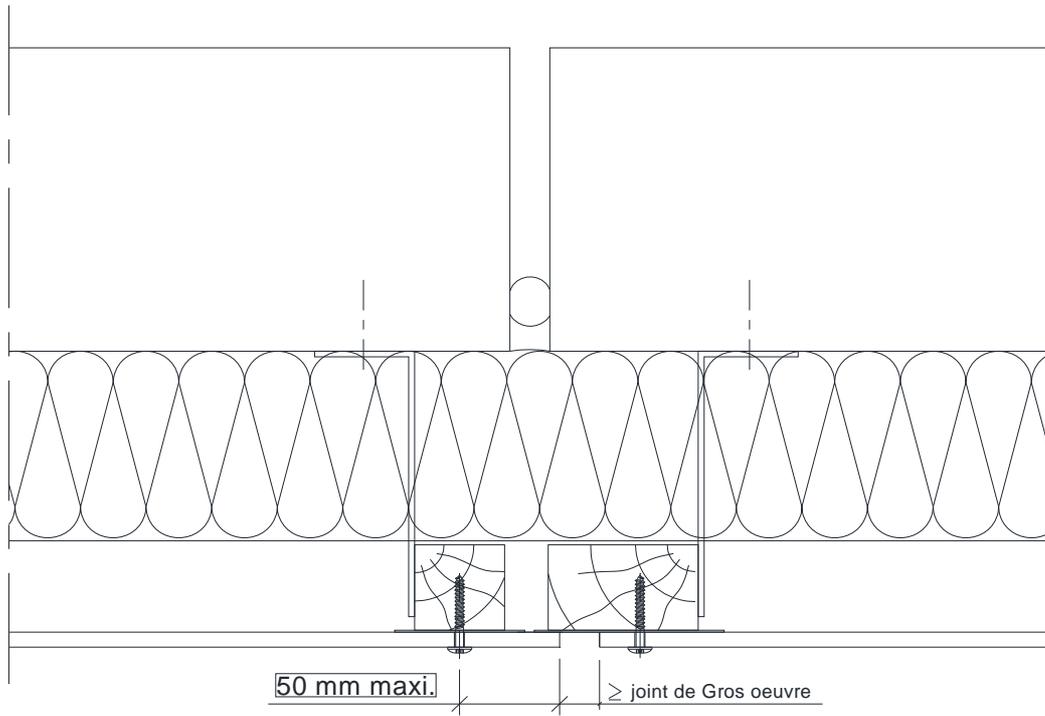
Joint de dilatation – Coupe horizontale - Pose en bardage
